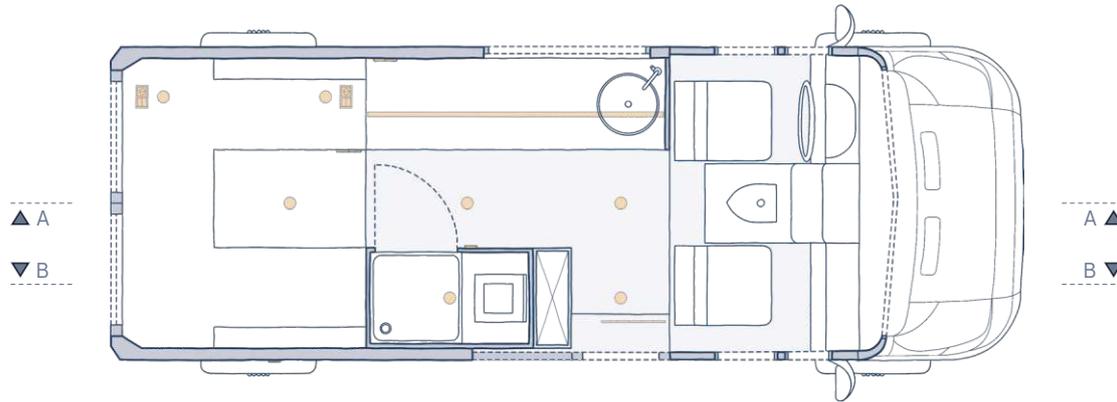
Campervan für zwei Personen - Beleuchtung und Steckdosen - Grundriss (Maßstab 1:50)
